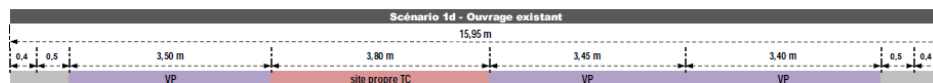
Profil en travers de l'ouvrage existant dans le scénario 1d
